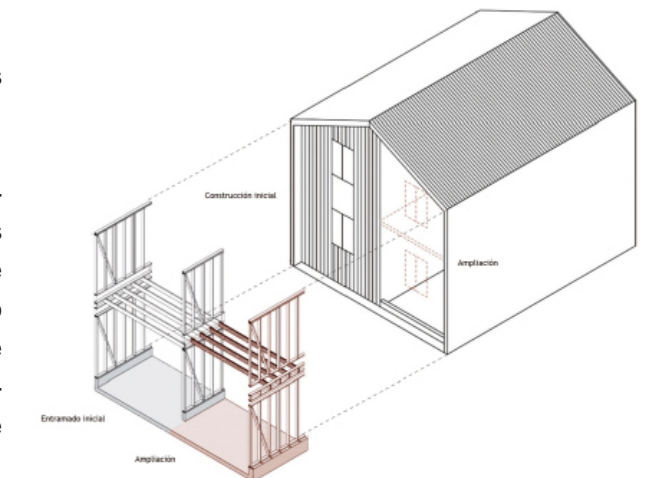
Sistema constructivo Villa Verde. Fuente: Calva, G.
